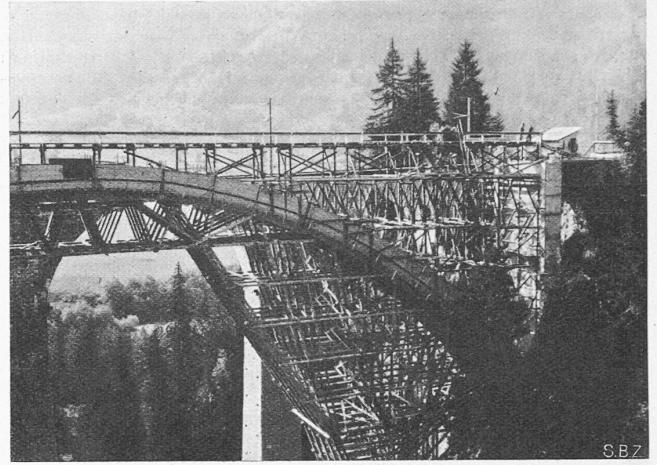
Lehrgerüst geschlossen, darüber Transportgerüst (26. Juli 38)
